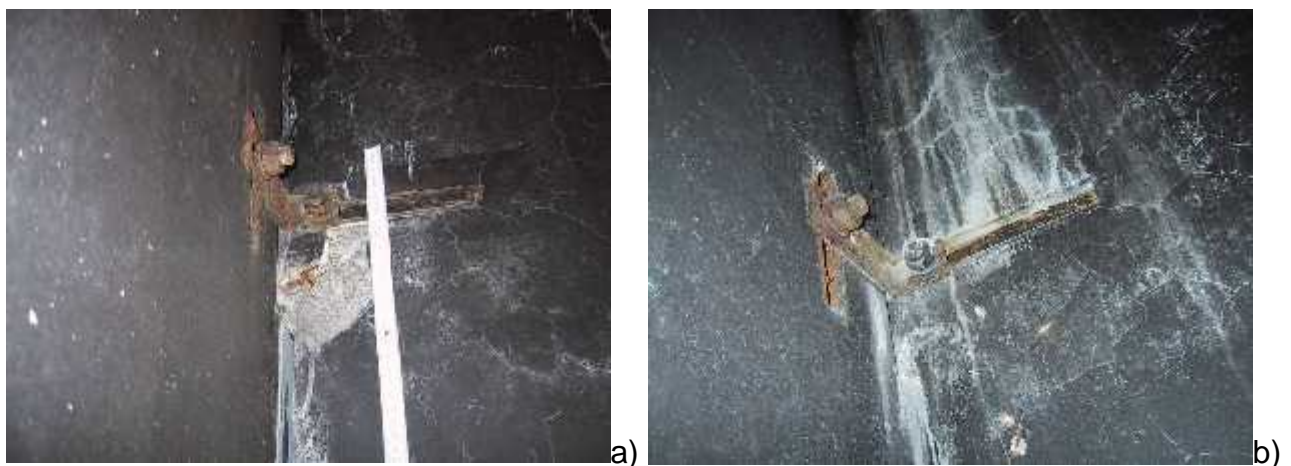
Korrodierte Verankerung der Fertigteilunterzüge der Schwimmhalle, a) Betonausbruch neben der korrodierten Verankerung und der Aufhängungskonsole, Bewehrungskorrosion und Netzrissbildung der Betonoberfläche, b) korrodierte Verankerung, Bewehrungskorrosion infolge nicht ausreichender Betondeckung und Netzrissbildung der Betonoberfläche
